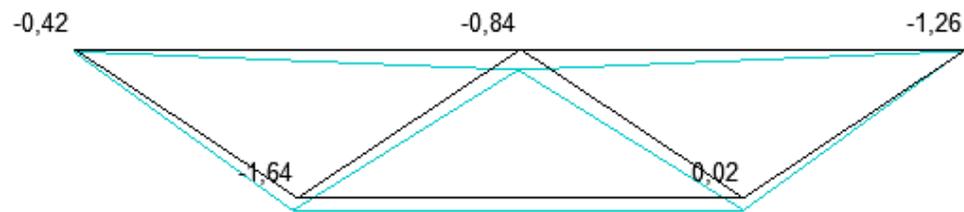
Перемещения в элементах фермы ФП1 (мм) по горизонтали в плоскости фермы
